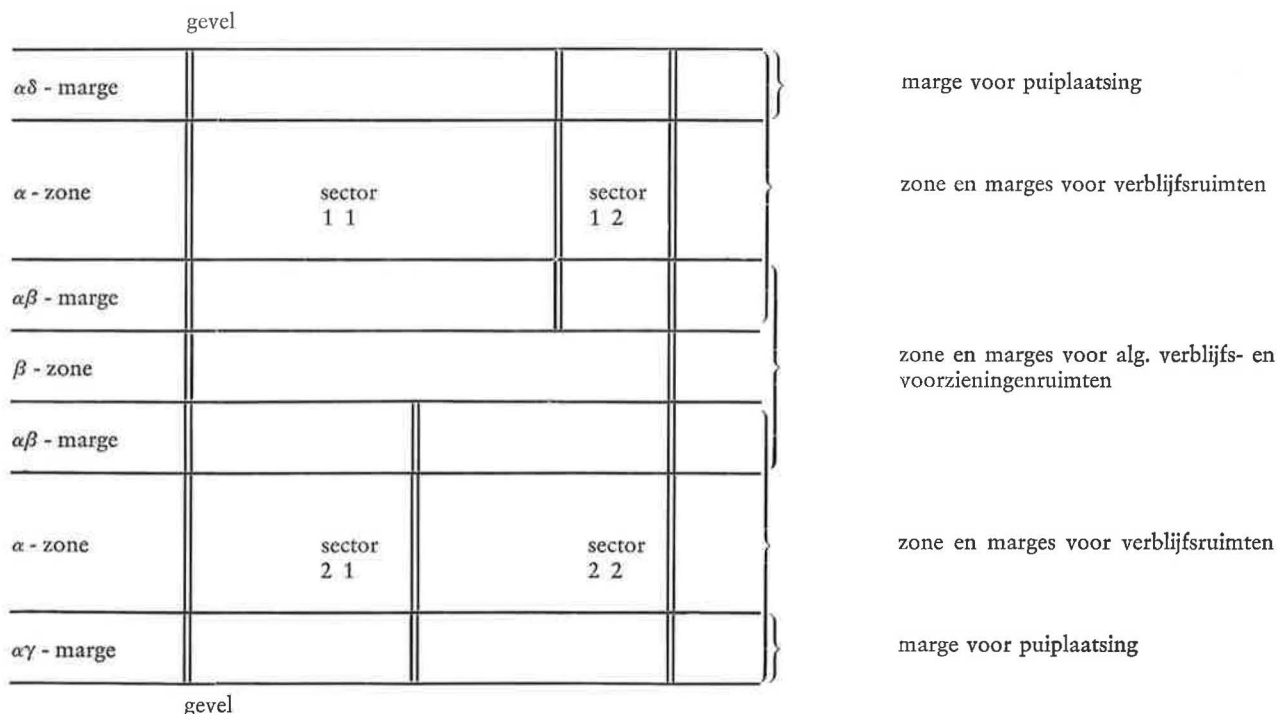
Voorbeeld van de door een woonstructuur gegeven indeling in zones en sectoren.
